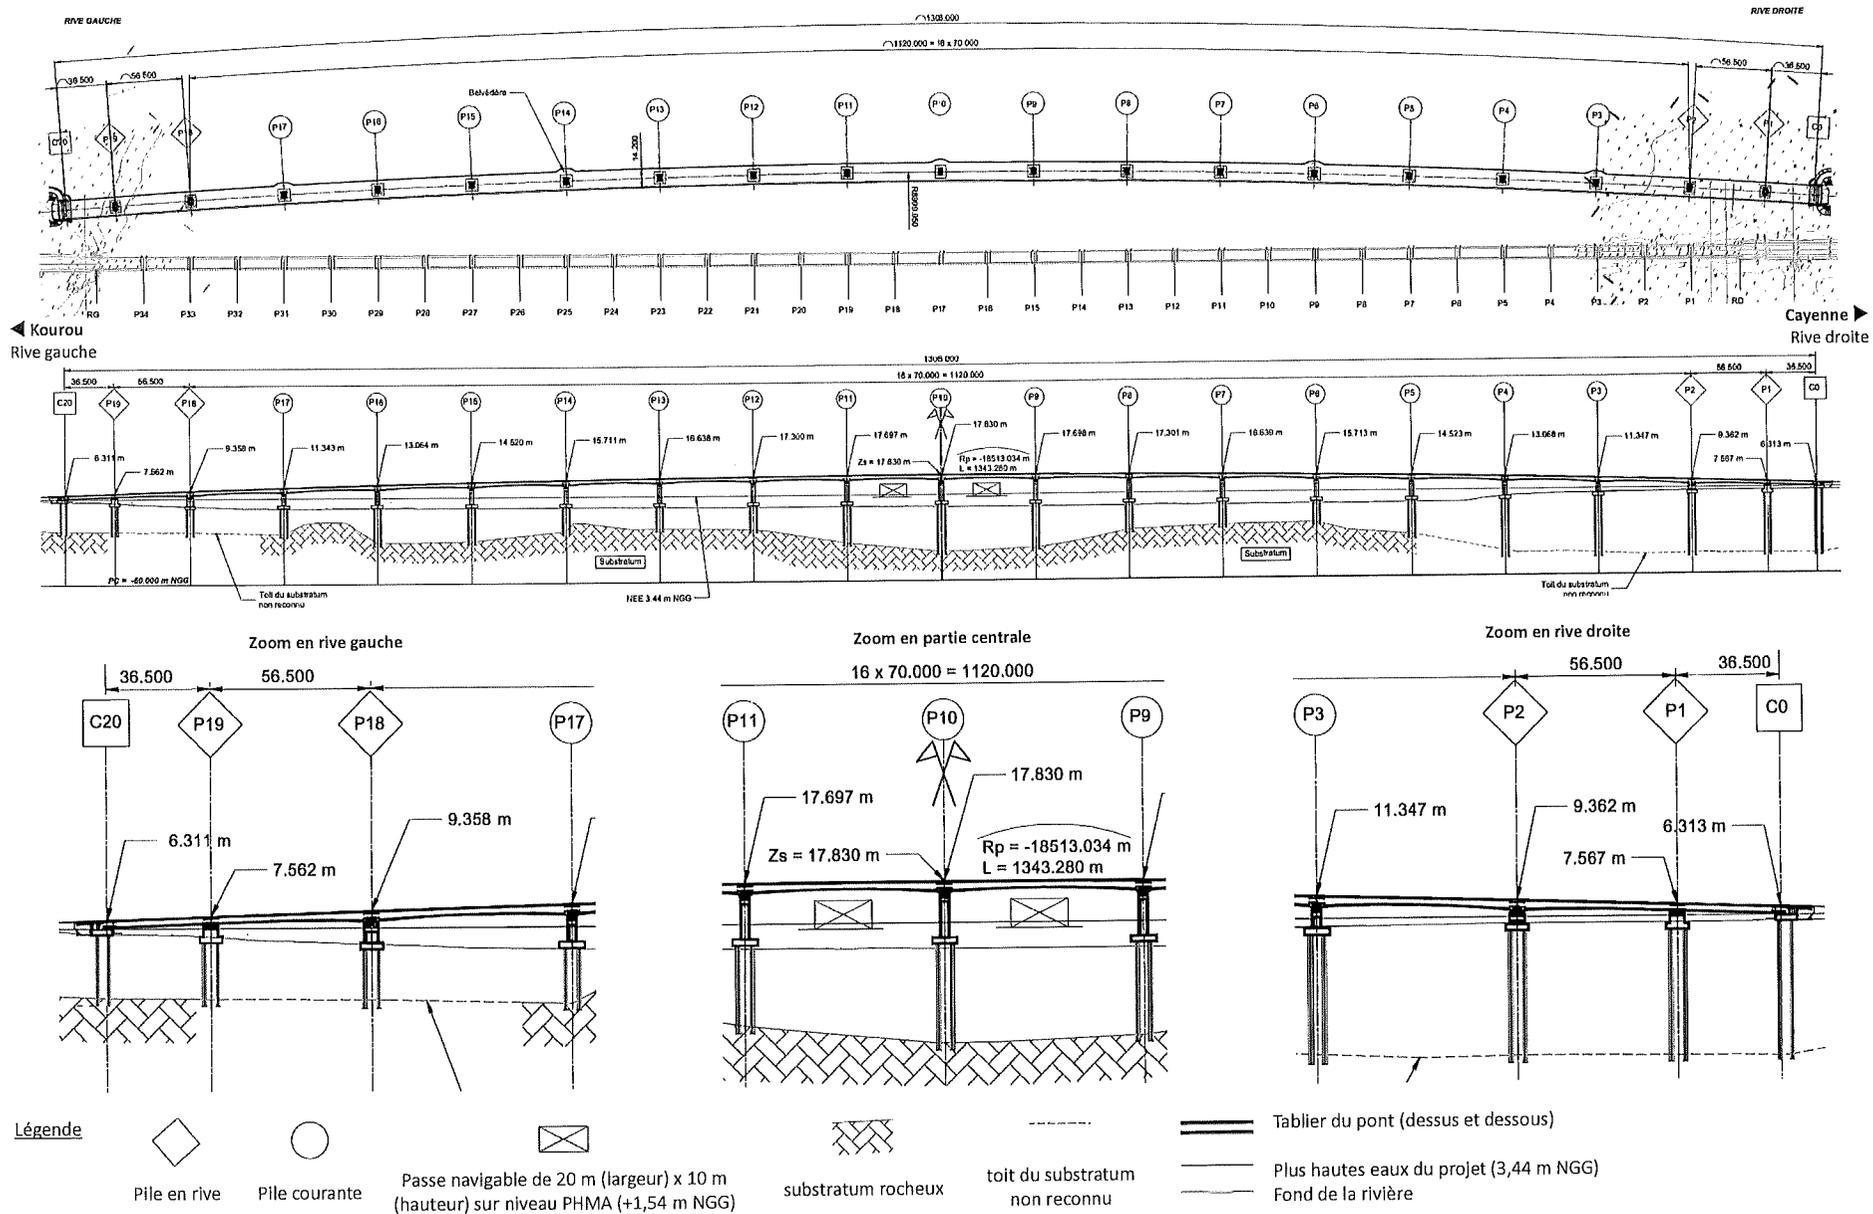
vue en plan et coupe longitudinale – solution avec tablier en béton de hauteur variable (source : Egis)
